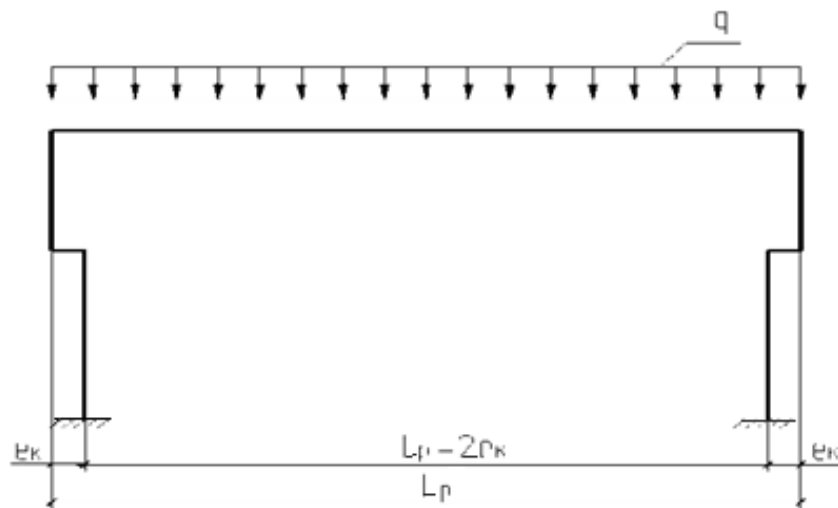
Схема распределения нагрузки от собственного веса покрытия
